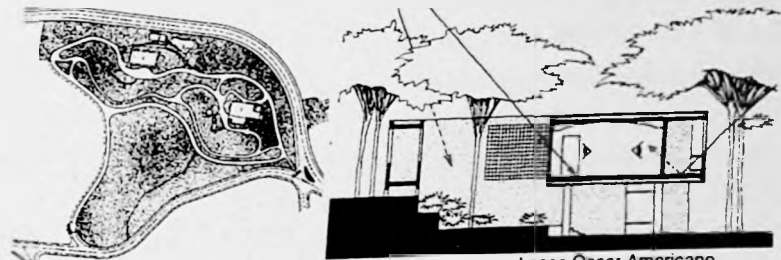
e 579 Planta de implantação e croqui corte transversal casa Oscar Americano.
